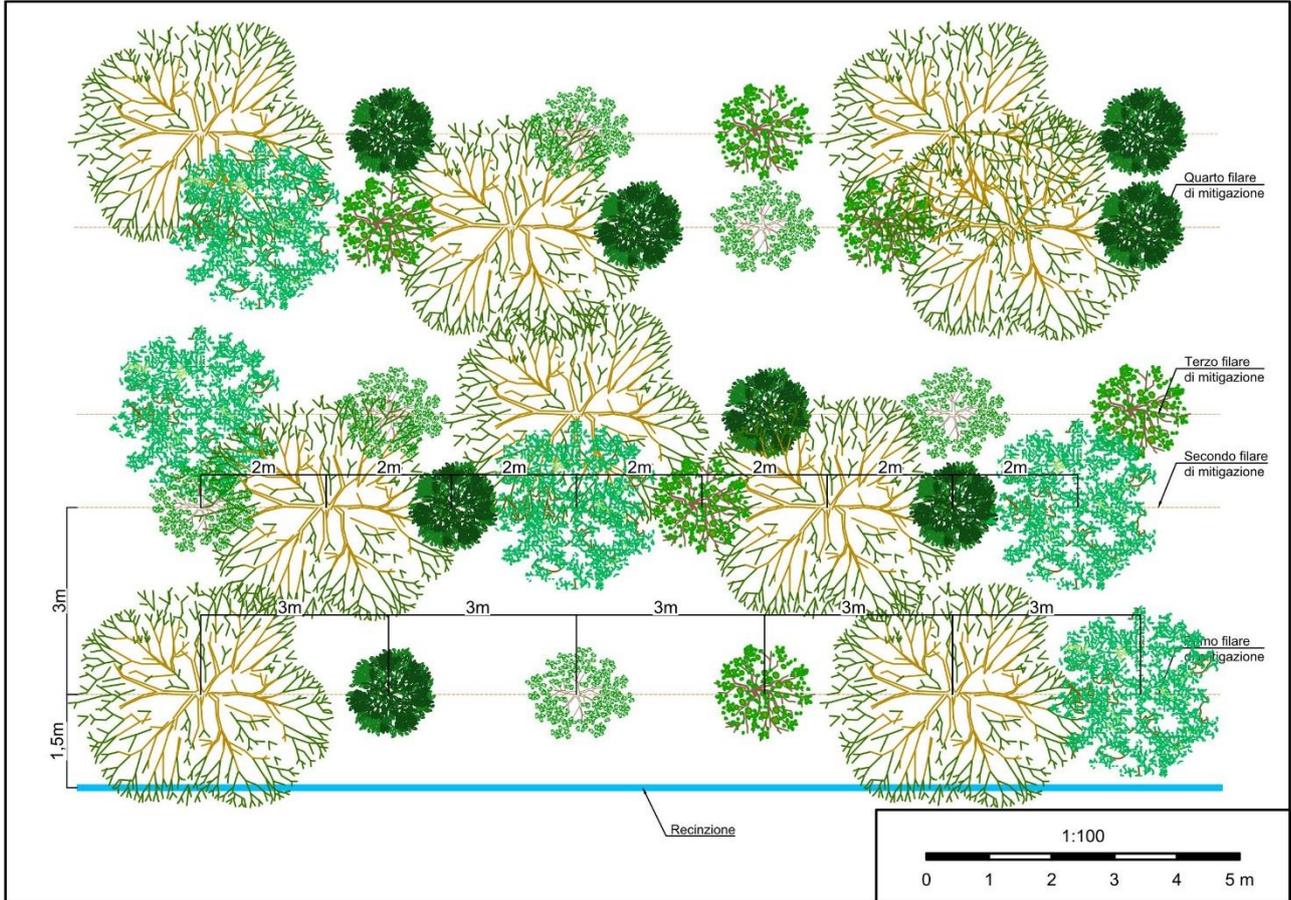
Schema piantumazione fascia di mitigazione "rinforzata"
